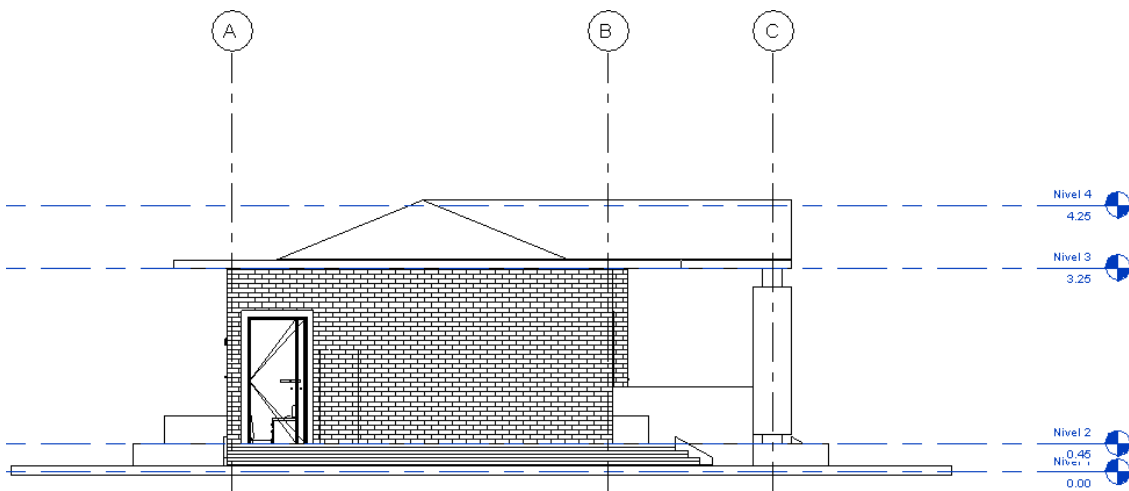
Fachada posterior del levantamiento 3D a través de Autodesk Revit.
